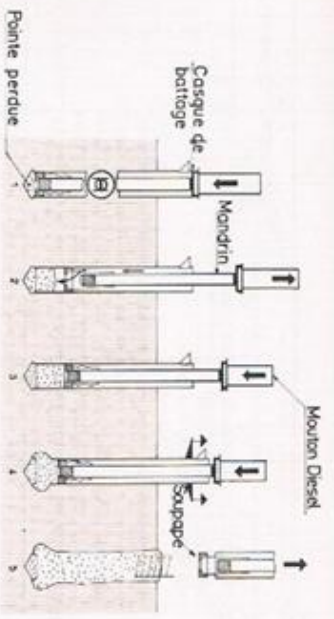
PIEU MOULÉ A TUBE BATTU, A BASE OBTURÉE.
